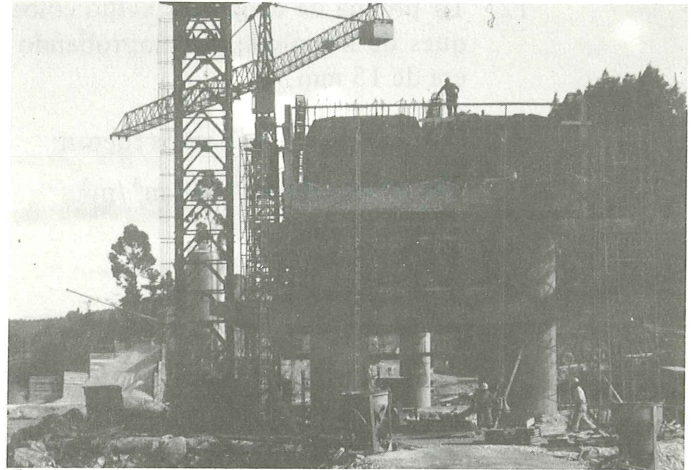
Hormigonado tramo entre pilas: losa inferior.
